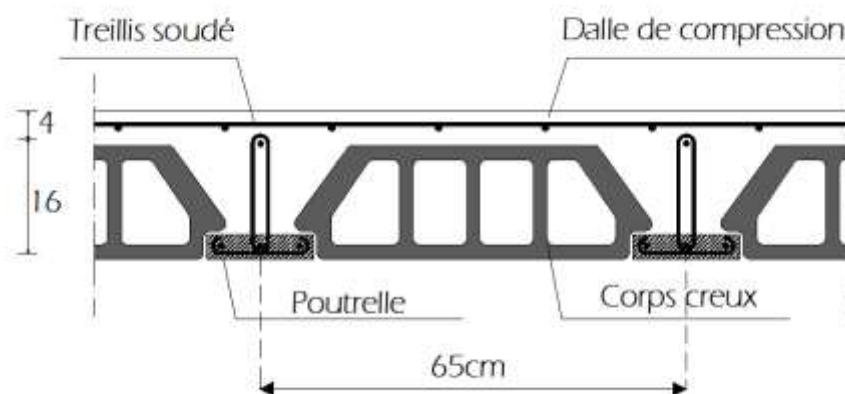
Coupe transversale d'un plancher en corps creux.
